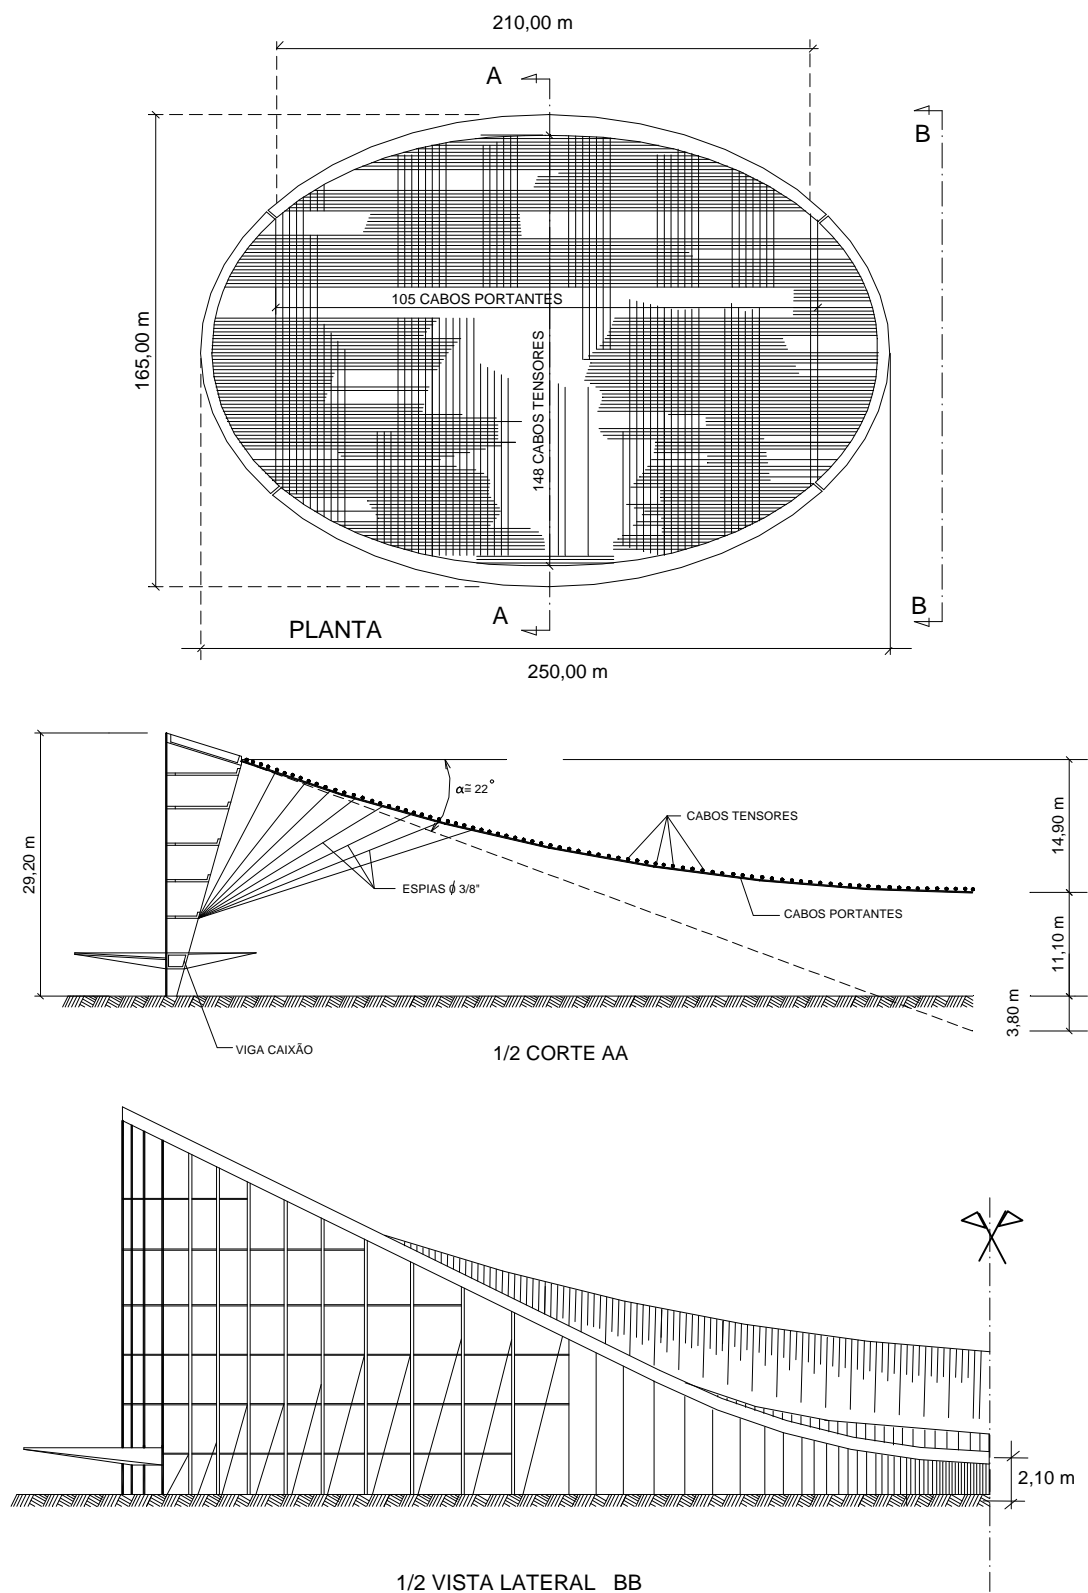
Planta, corte e vista lateral do Pavilhão de São Cristóvão.
